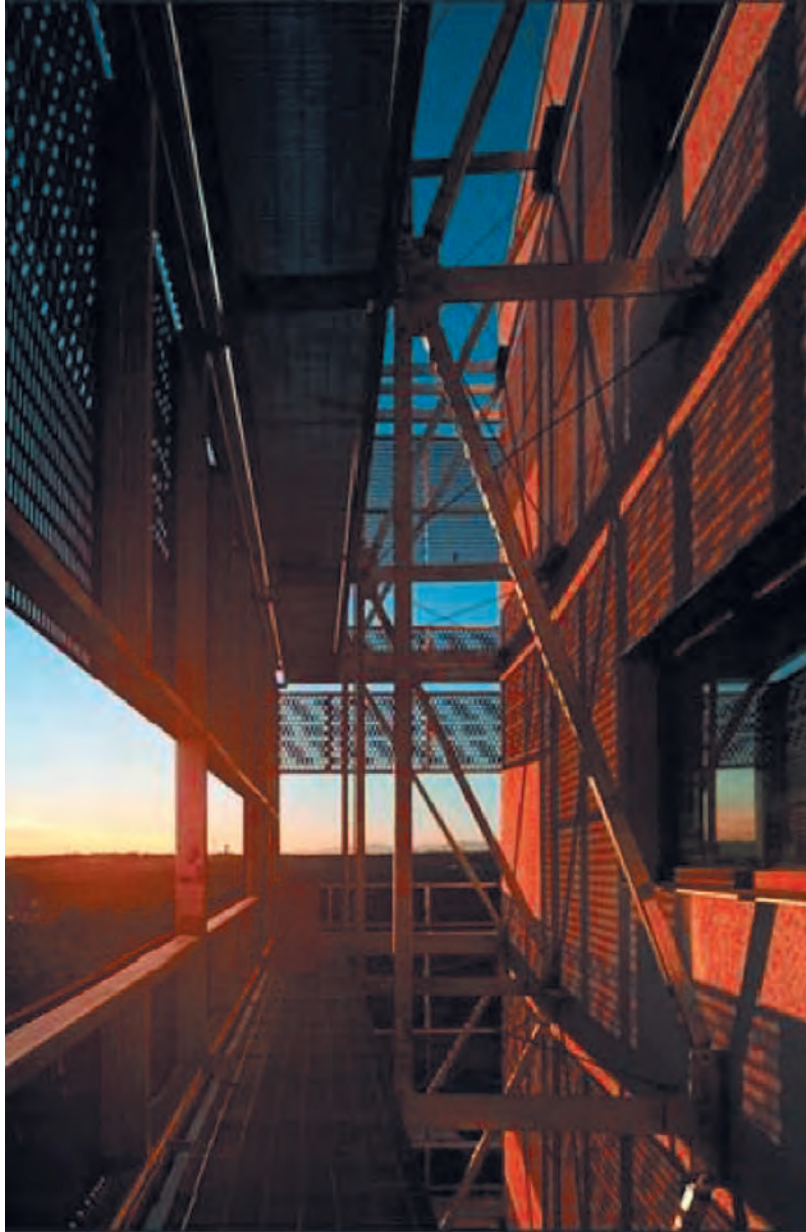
Fachada sur de la sede de IDOM en Madrid. Doble piel metálica perforada separada a más de un metro de la fachada para facilitar su ventilación natural.
